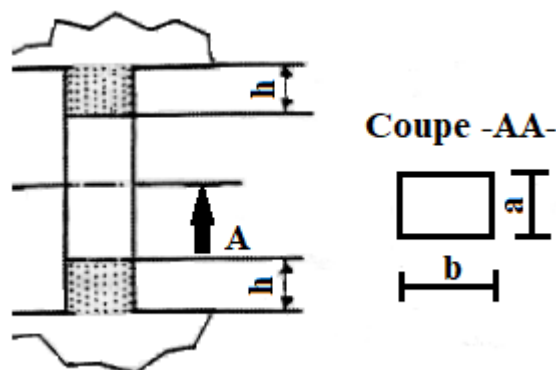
Zones de continuité mécanique des armatures des poteaux secondaires
